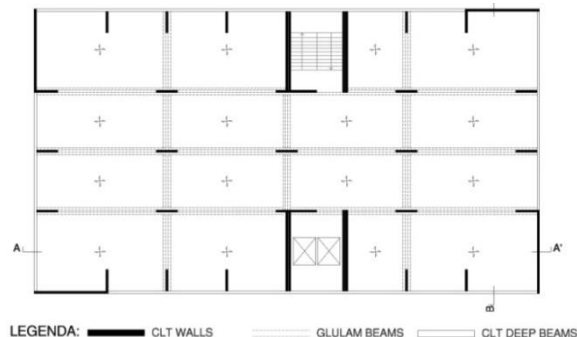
Planta do Sistema Estrutural Proposto com o *UT System
